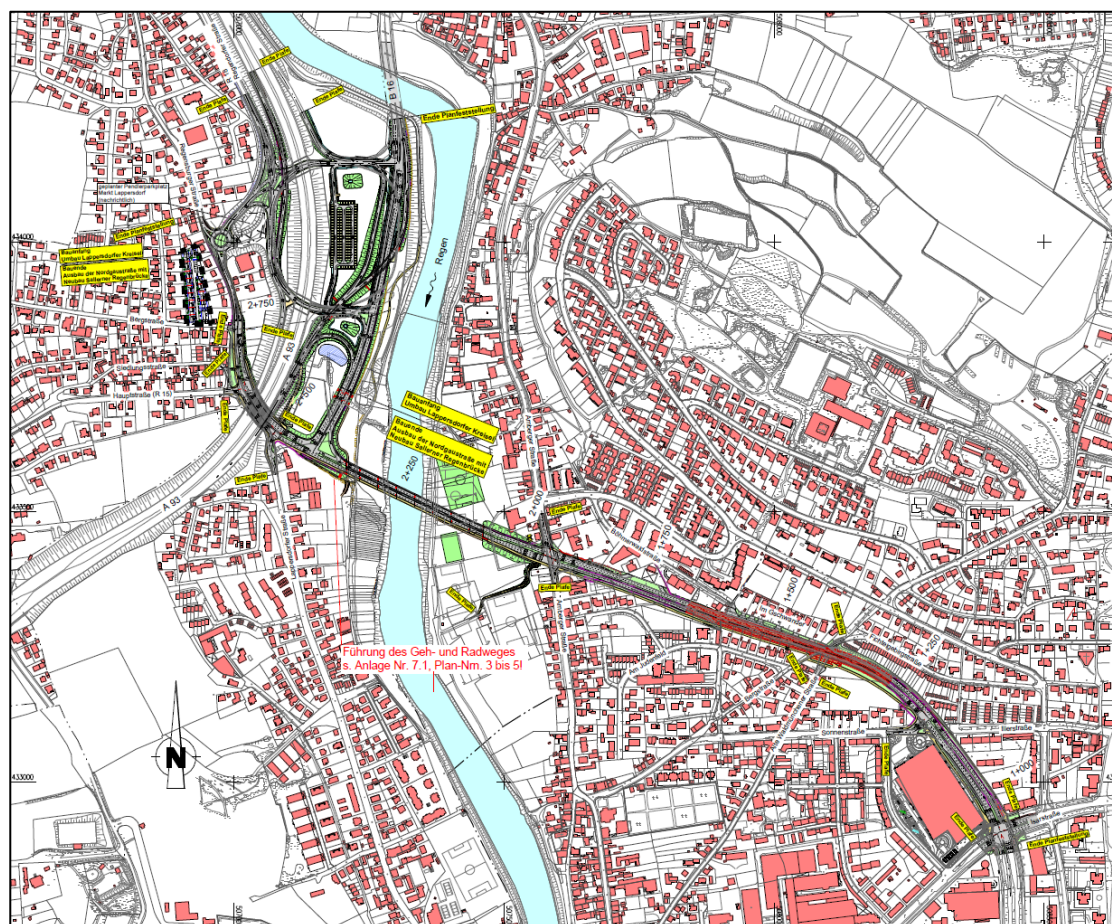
Übersichtslageplan (Ausschnitt; BBI GmbH 2008)
